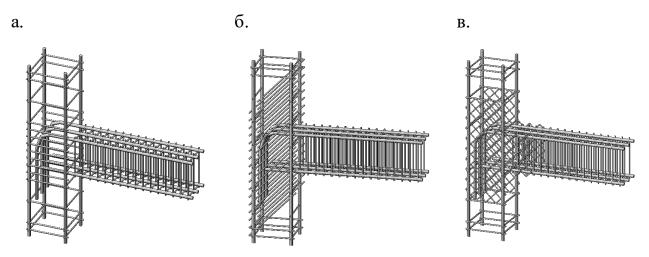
Варианты армирования центральной части узла: а — продольной арматурой и поперечными стержнями, перпендикулярными к оси колонны (№1); б — продольной арматурой и наклонными поперечными стержнями (№2); в — продольной арматурой и сетками (№3)
